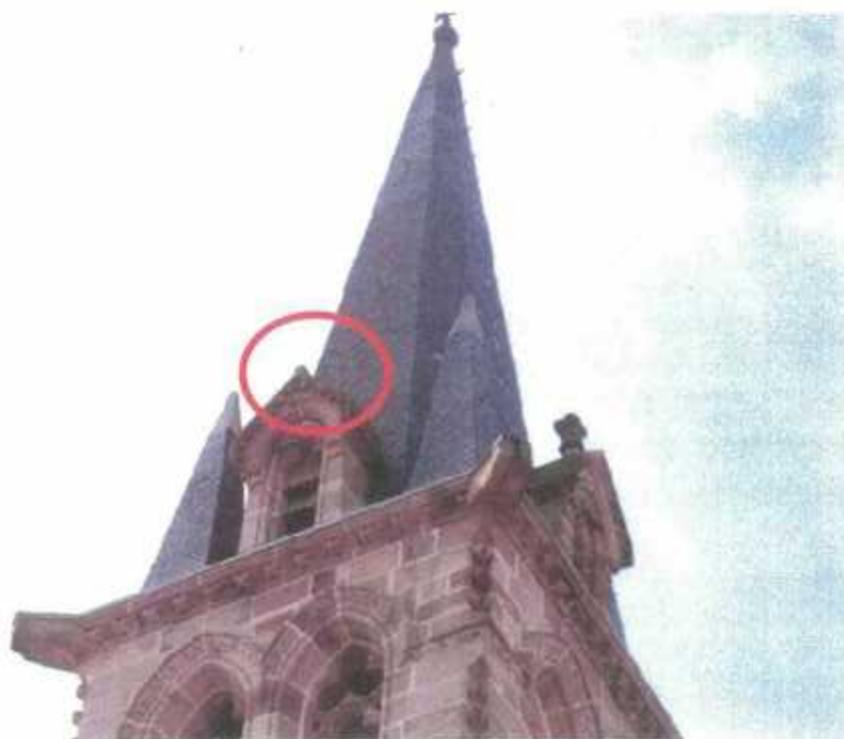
fissuration sur le mur de l'église.
